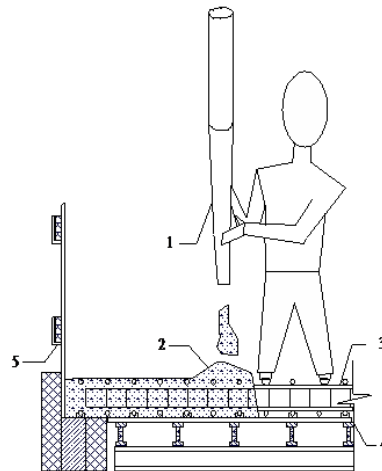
Укладка бетона: 1 – наконечник стрелы автобетононасоса; 2 – укладываемый бетон; 3 – арматурная сетка; 4 – конструкция опалубки перекрытия; 5 – инвентарное ограждение.
